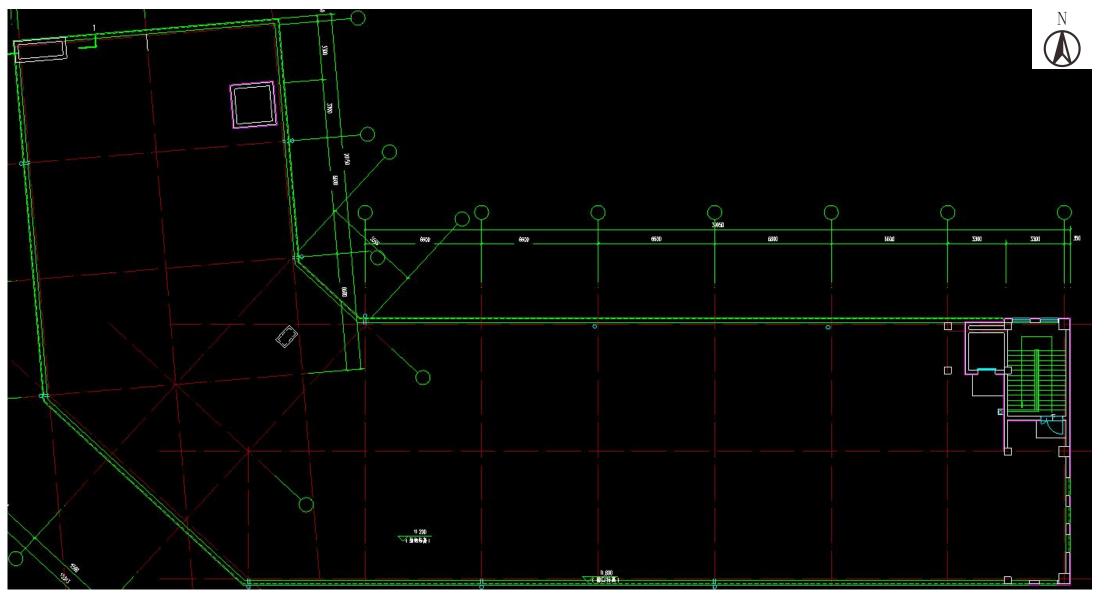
2#楼 3 层平面布置图 (1: 100)
